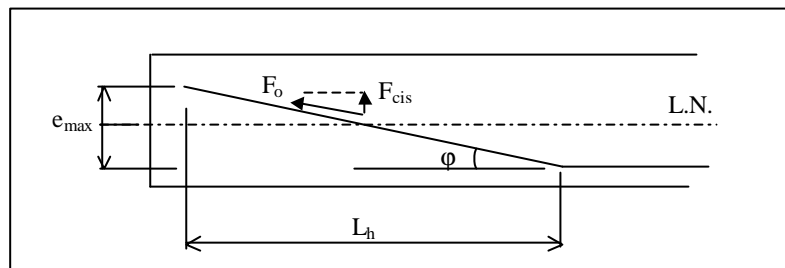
Reforço através de armadura longitudinal externa protendida
